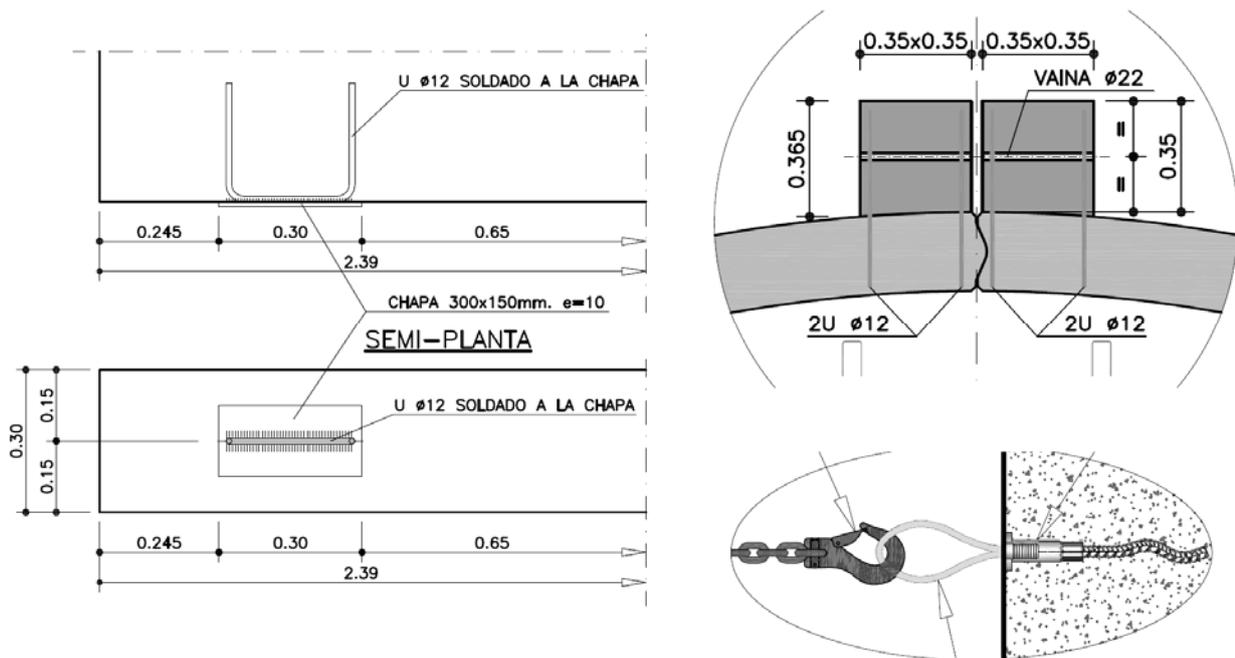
Detalles para traslación de pares de piezas: chapas de deslizamiento, eslingas en canto y barras postesadas
